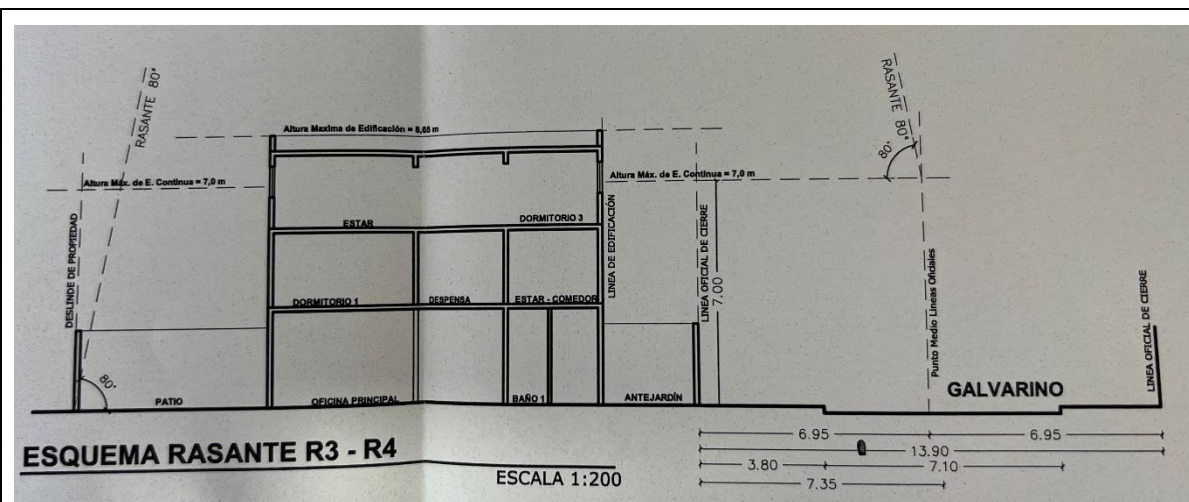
, esquemas de rasante en plano N° 1 de arquitectura
